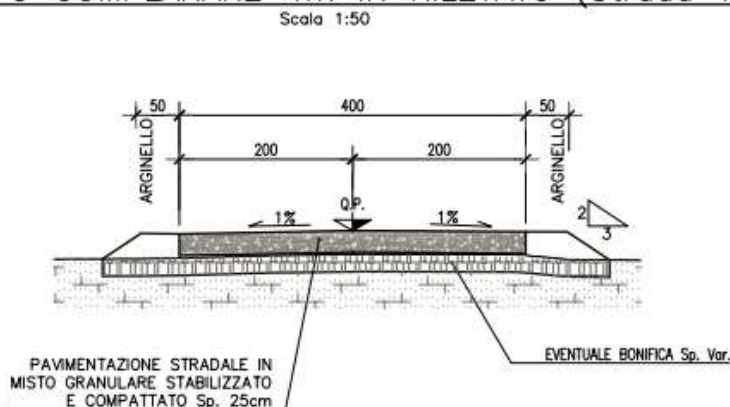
Sezione tipo complanare 5,5 m in rilevato
